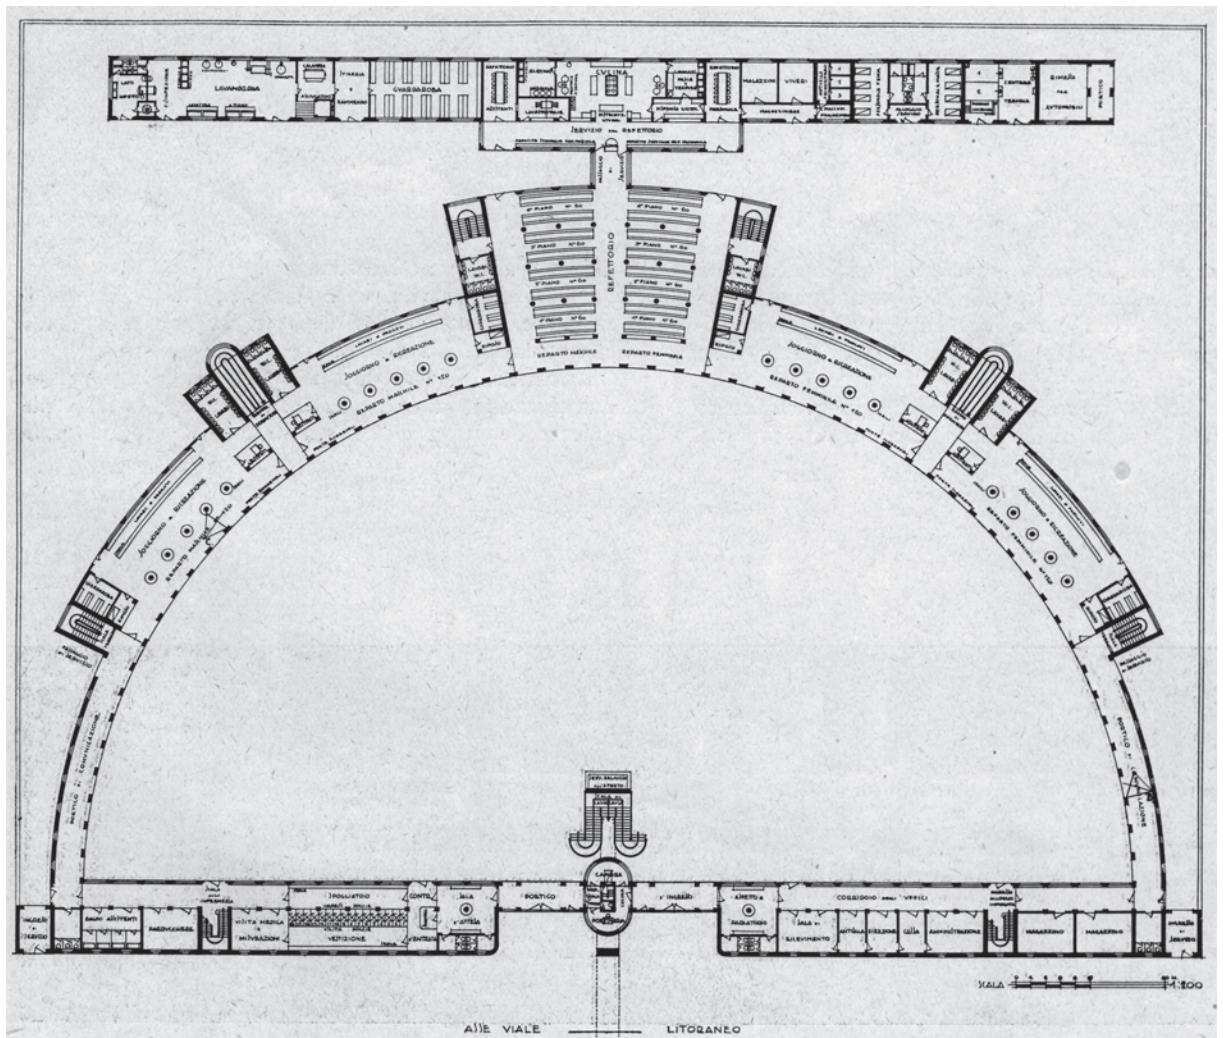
Ernesto Salviati, Entwurf (1.Preis) im Rahmen des Wettbewerbs zur Errichtung einer Ferienkolonie des Unternehmens Montecatini bei Marina di Ravenna 1936: Grundriss EG
